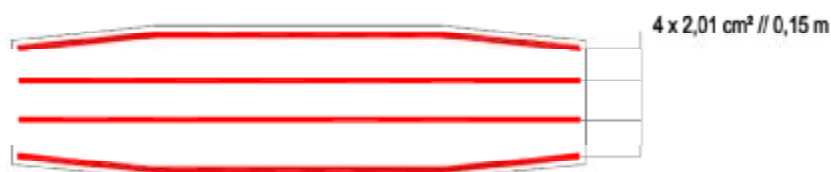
Esquematização das armaduras de esforço transverso para a transversal dos pilares
